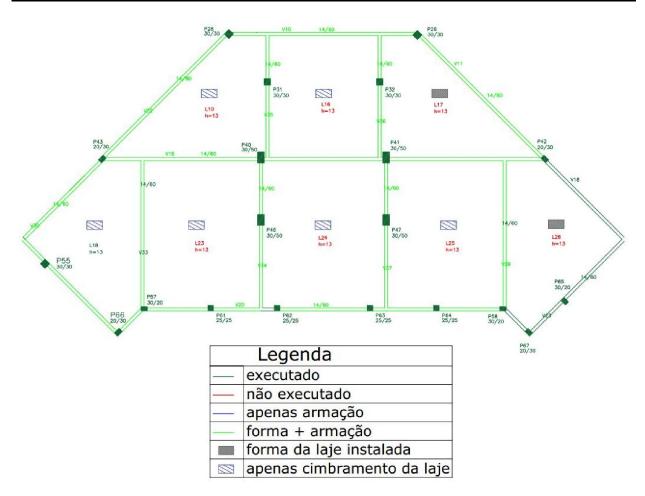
Mapa iluminado do HALL do pavimento de cobertura.
